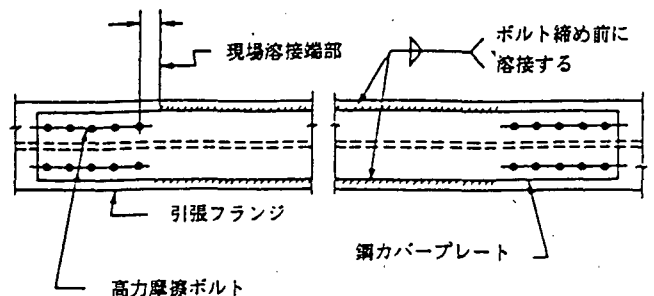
疲労損傷による亀裂を減少させるカバープレートエンドのボルト締
